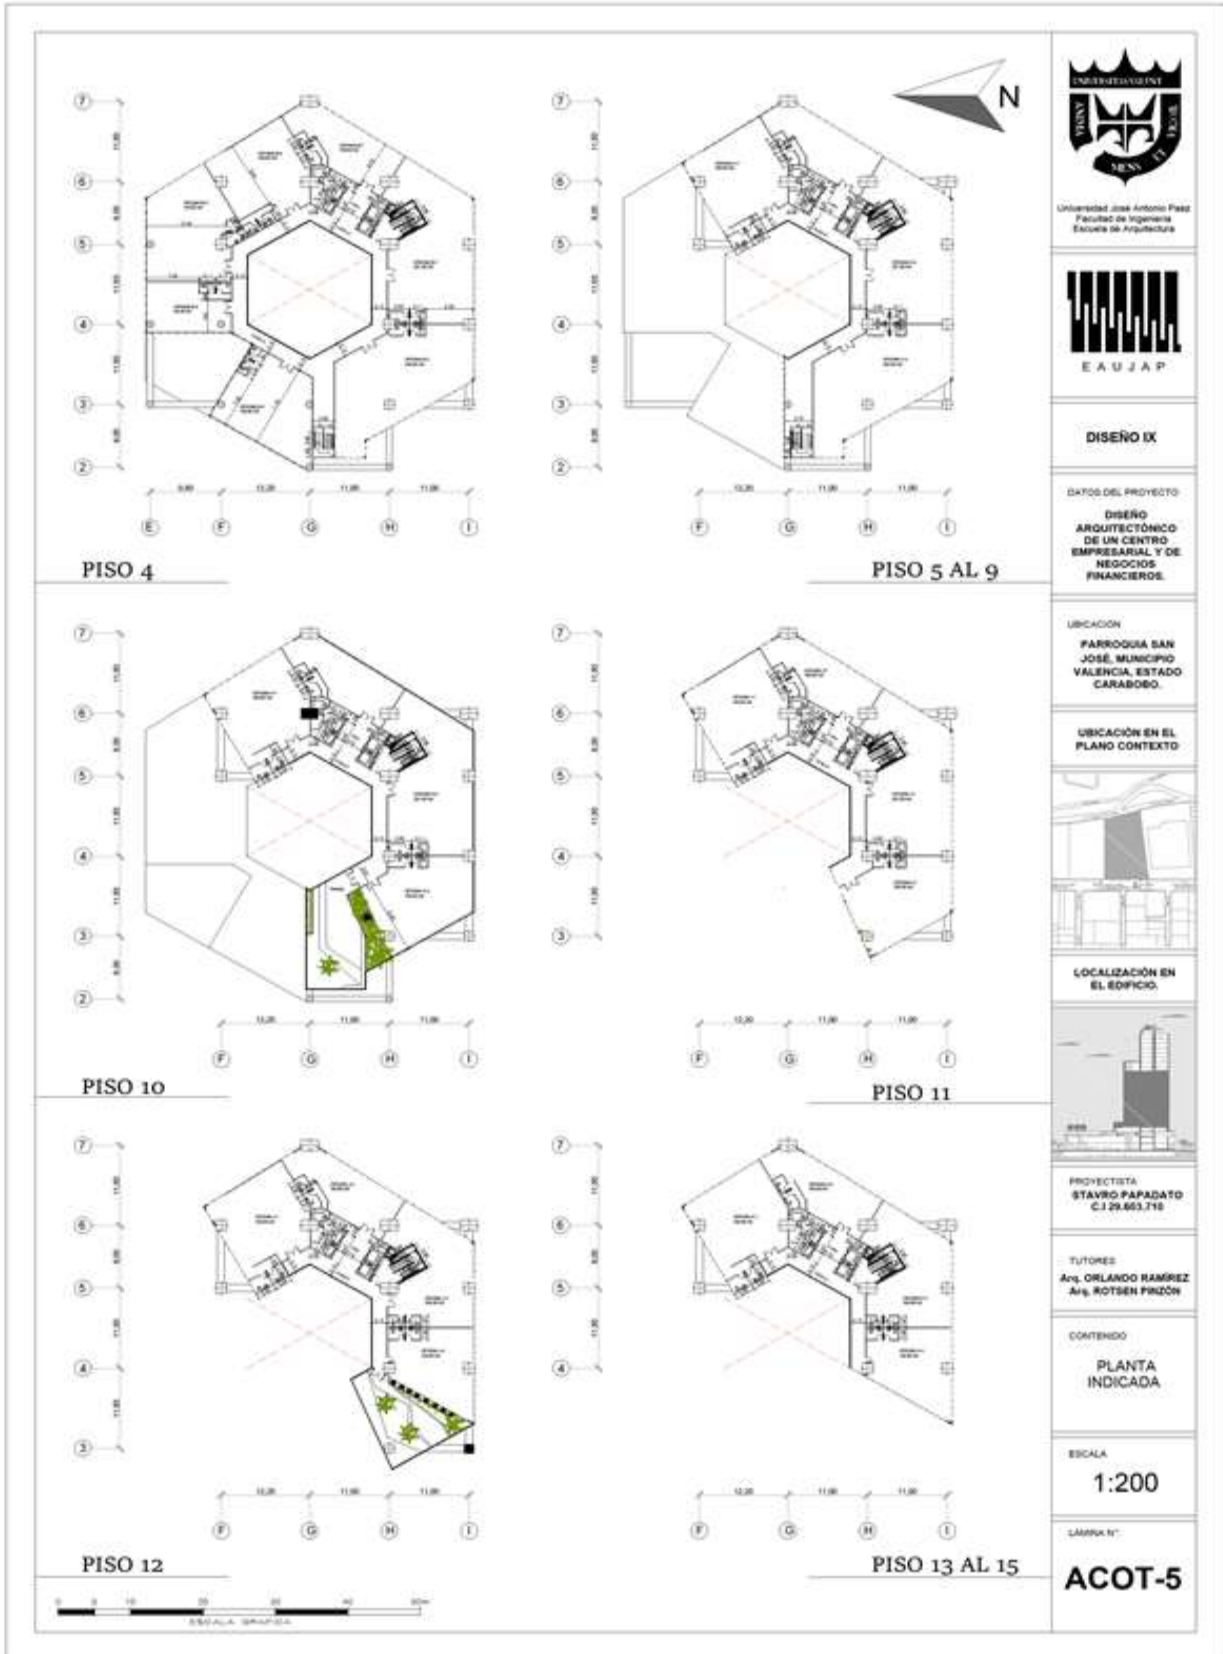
ACOT – 5 Planta Indicada Piso 4 al Piso 15 Fuente: El Autor (2023)
